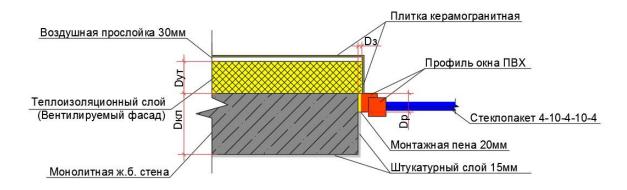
Монолитная стена с наружным утеплением типа вент. фасад
